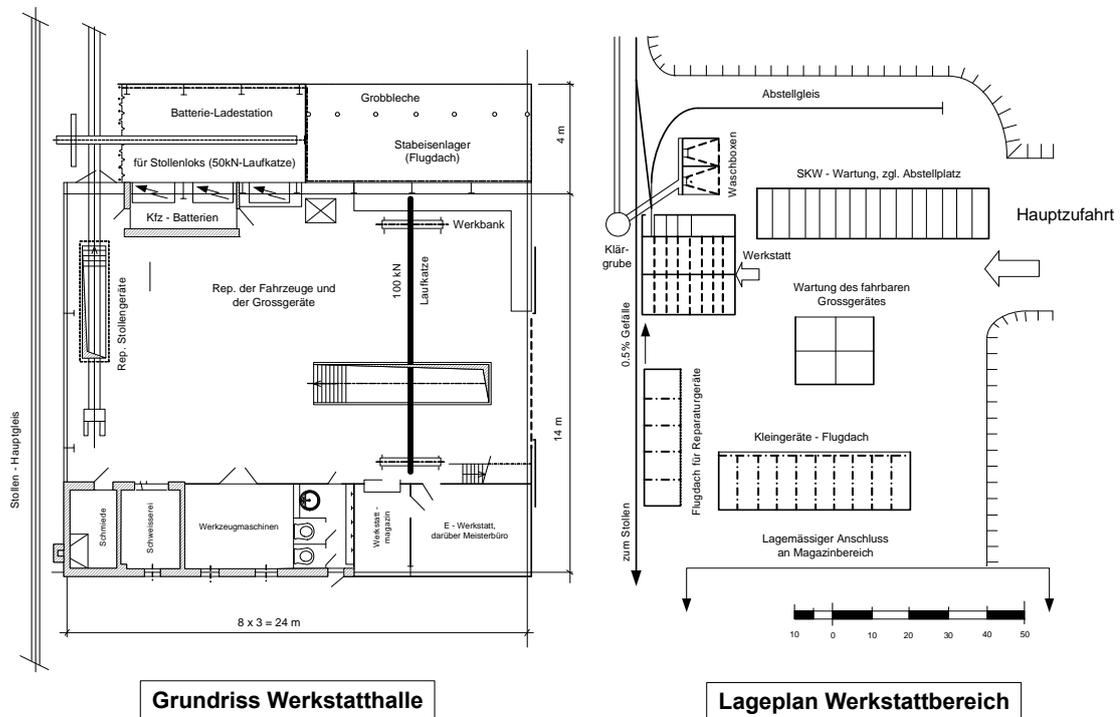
Hauptwerkstatt einer Grossbaustelle [3]
